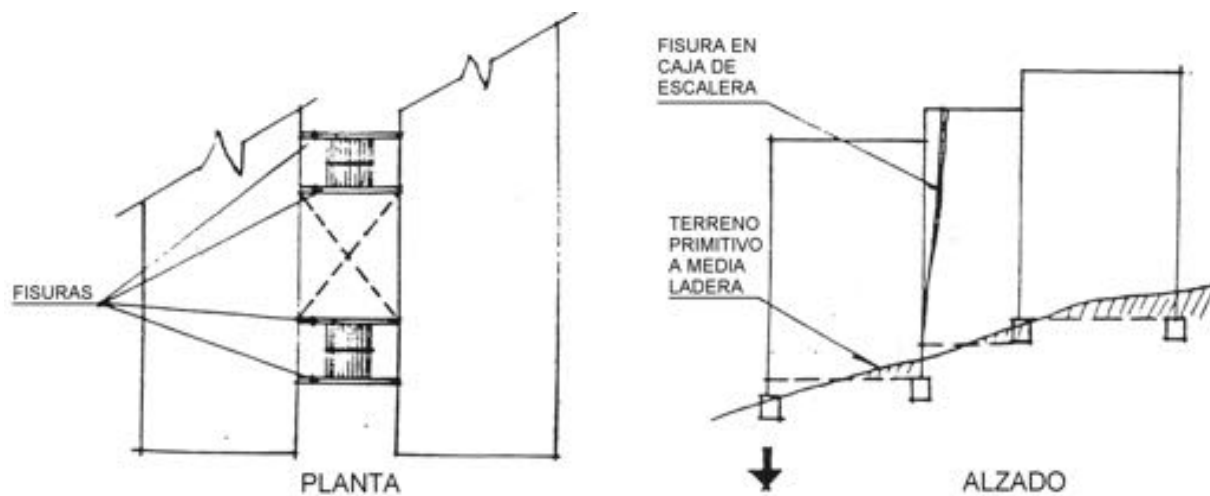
GIRO EN BLOQUES A MEDIA LADERA
